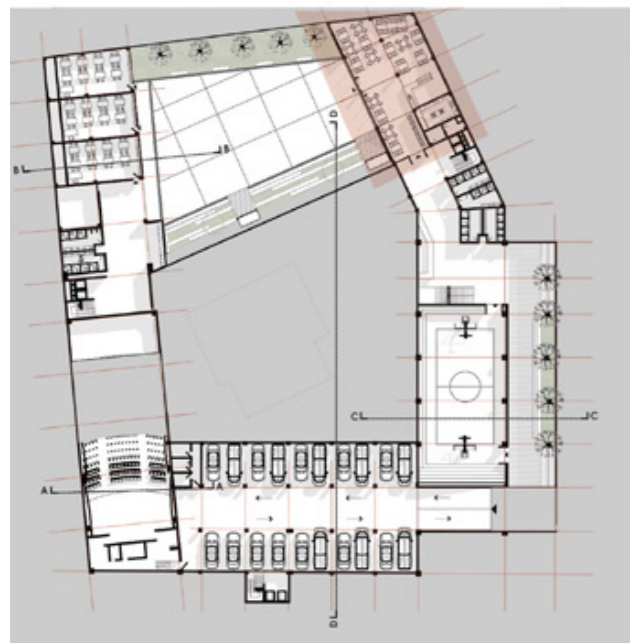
Esquema Planta subsuelo | Fuente: Elaboración propia
